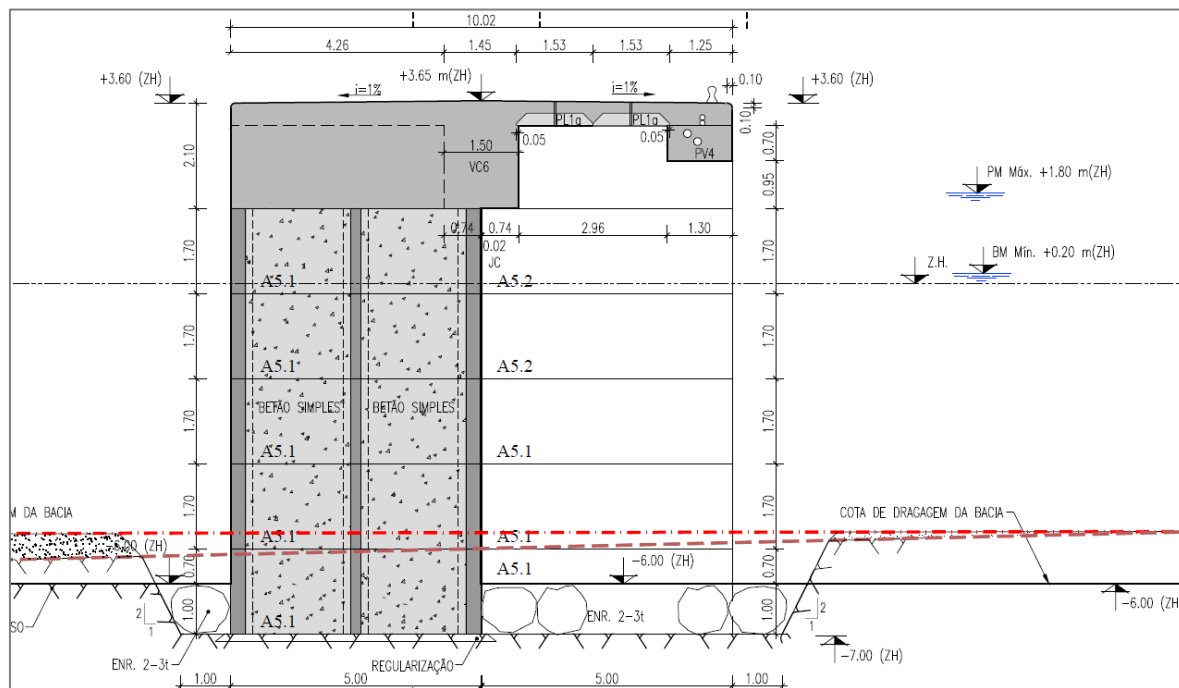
Obra de Abrigo Nascente - Perfil tipo da estrutura do troço poente
